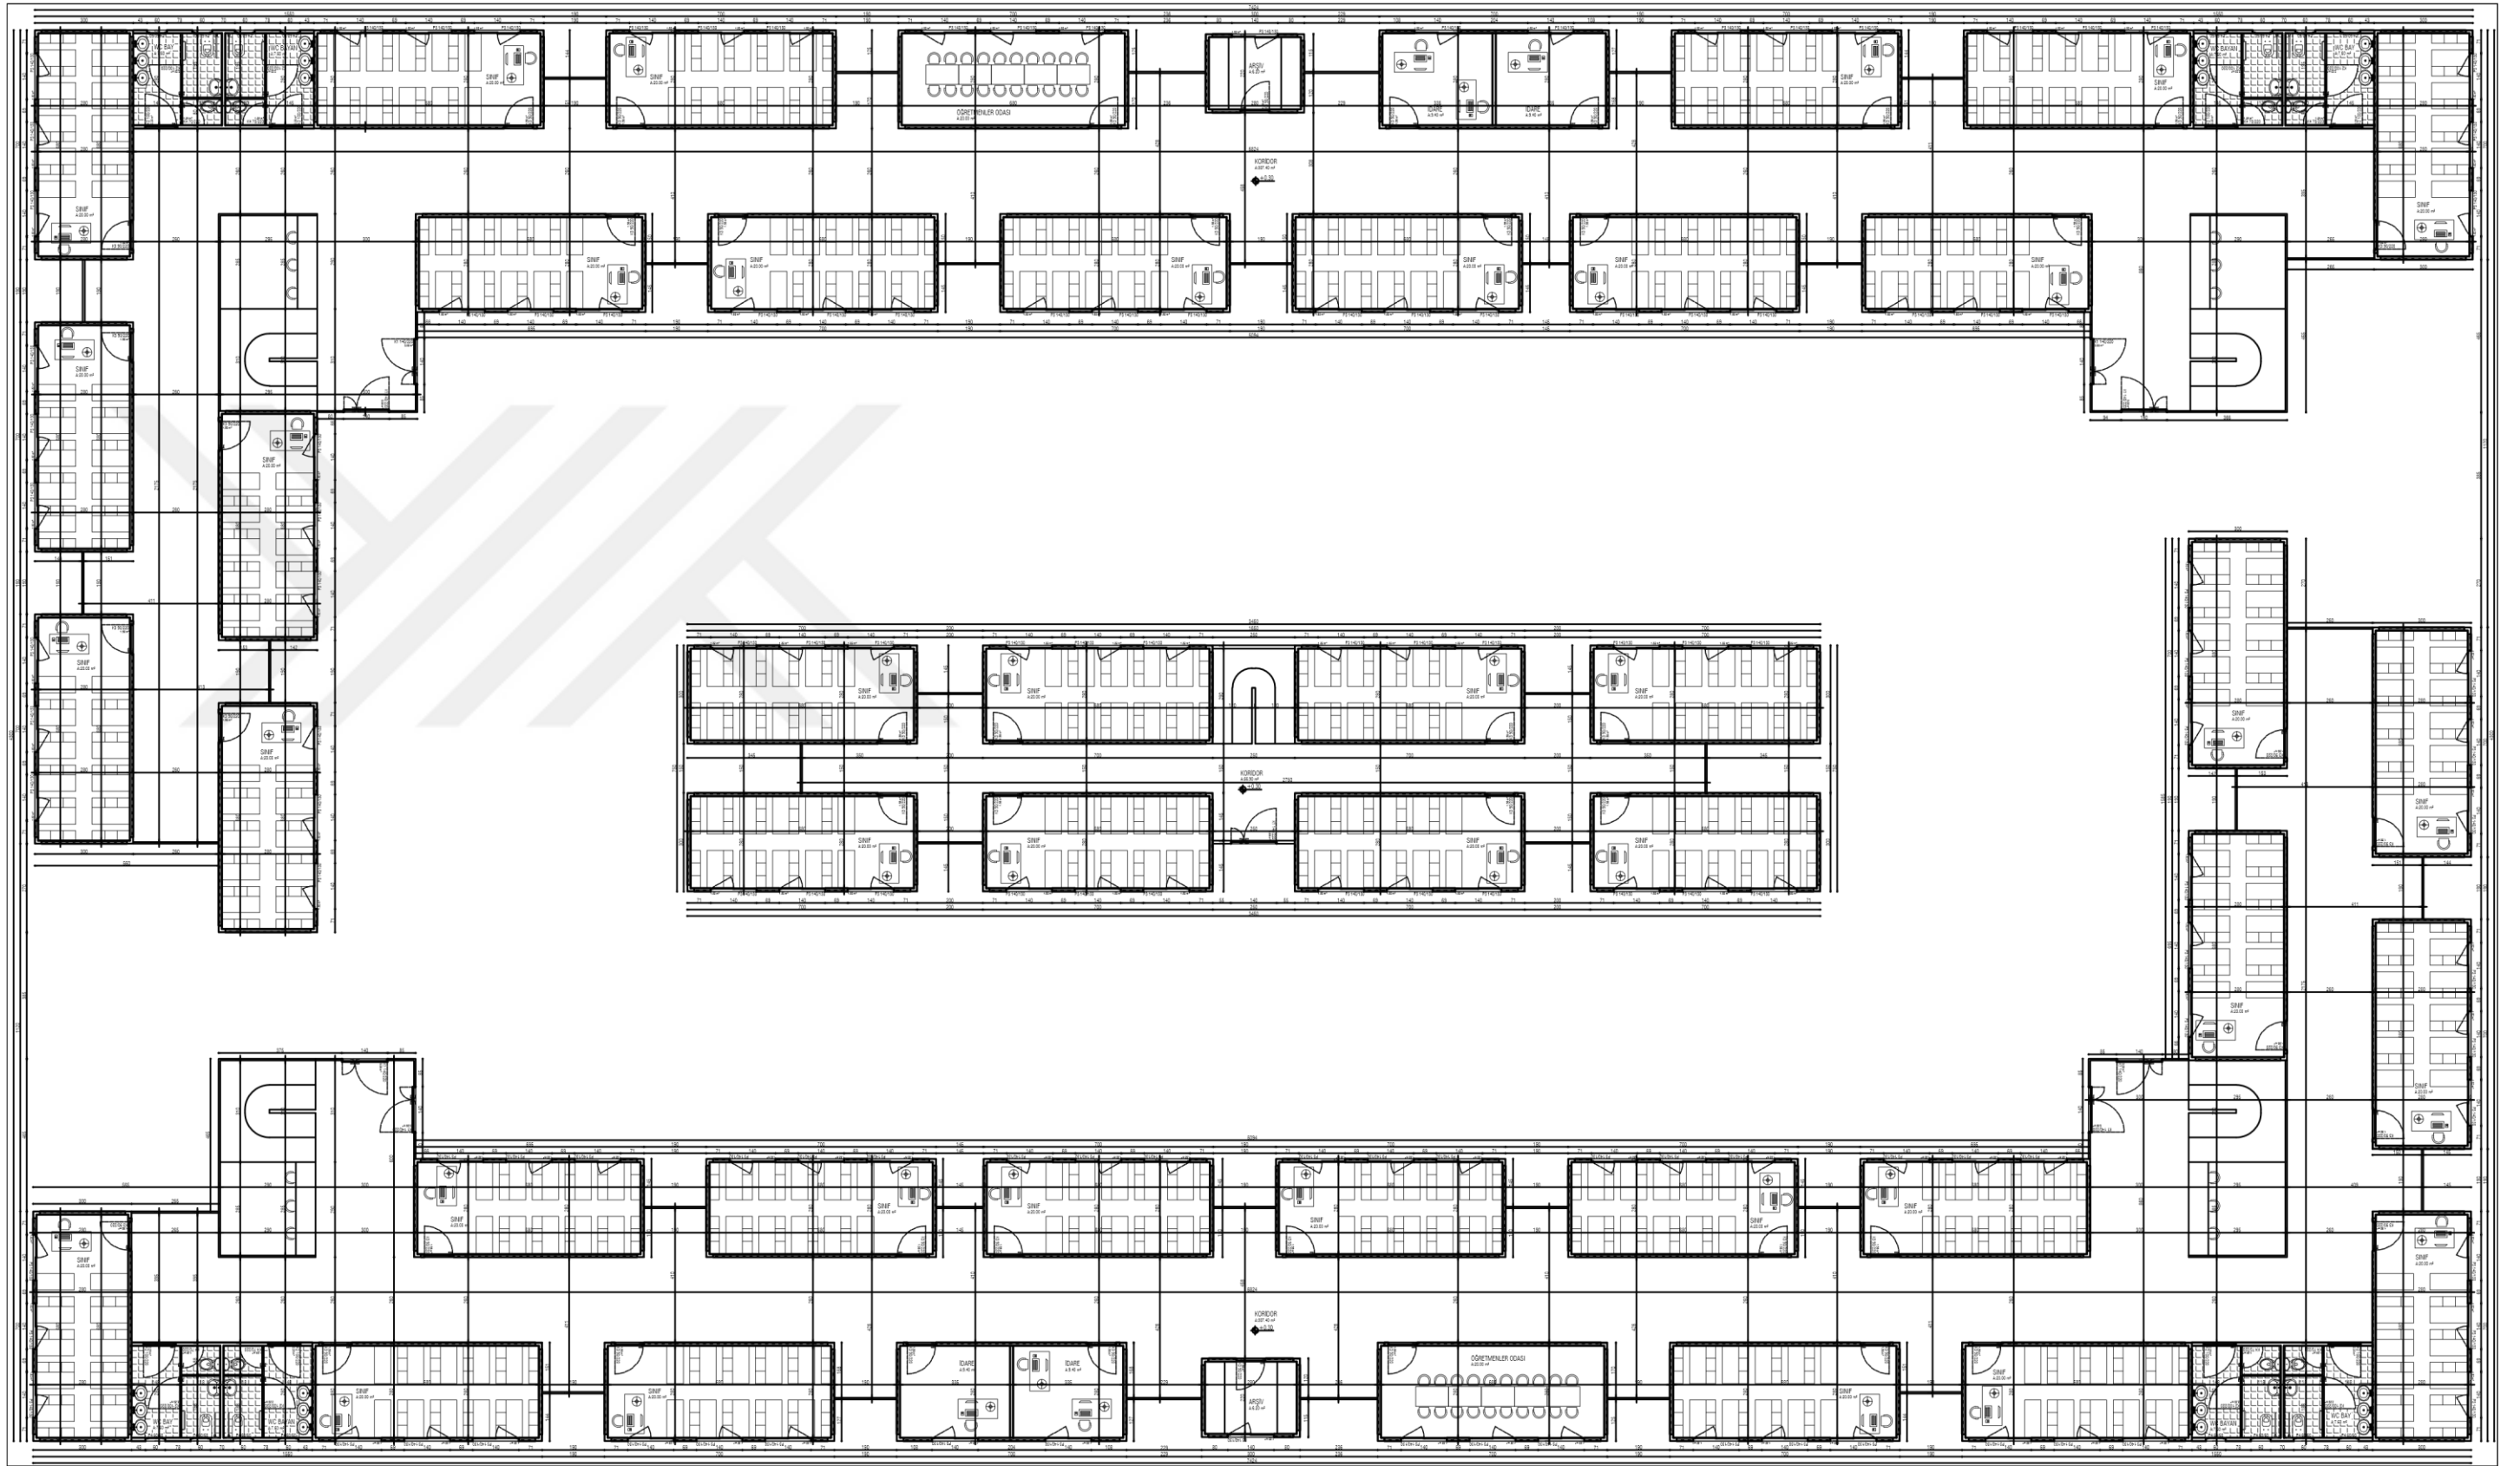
İlkokul Kat Planları (Ölçek : 1/150).
